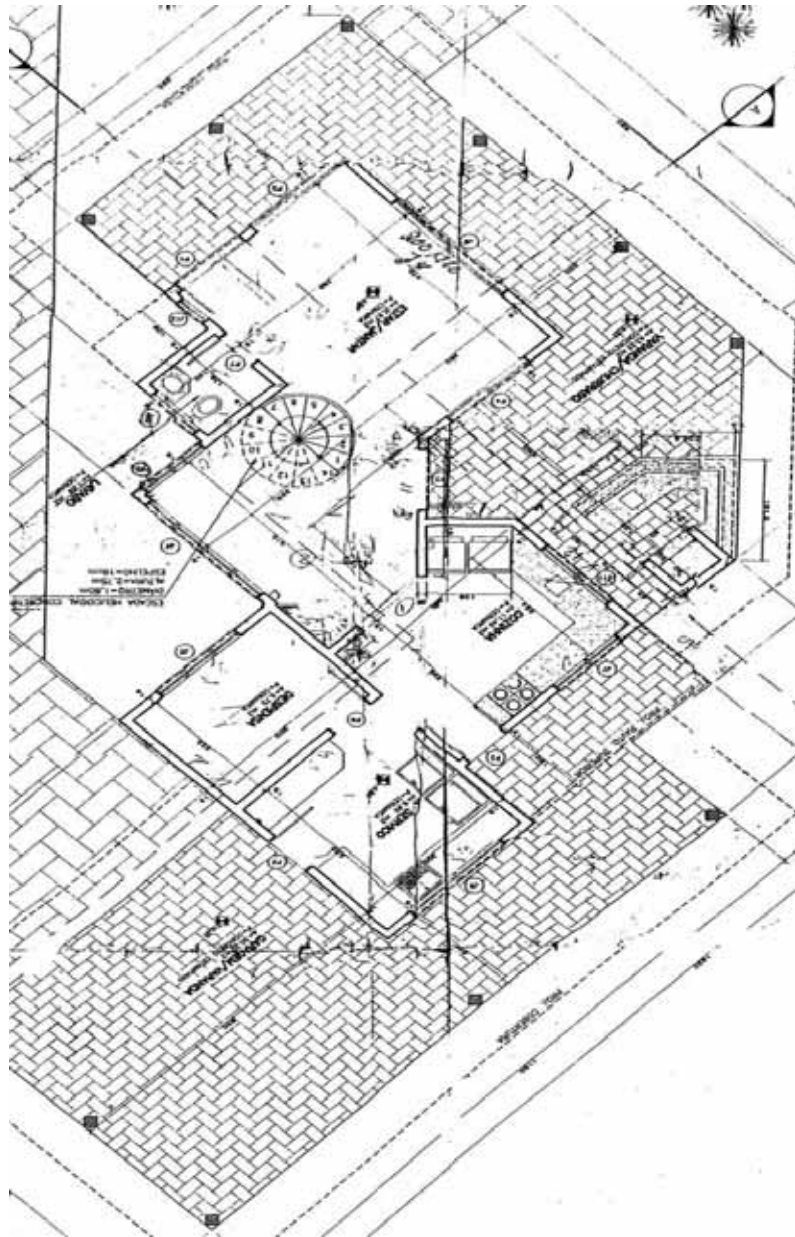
Projeto Estudo de Caso 1 - Planta Baixa Pavimento Térreo
